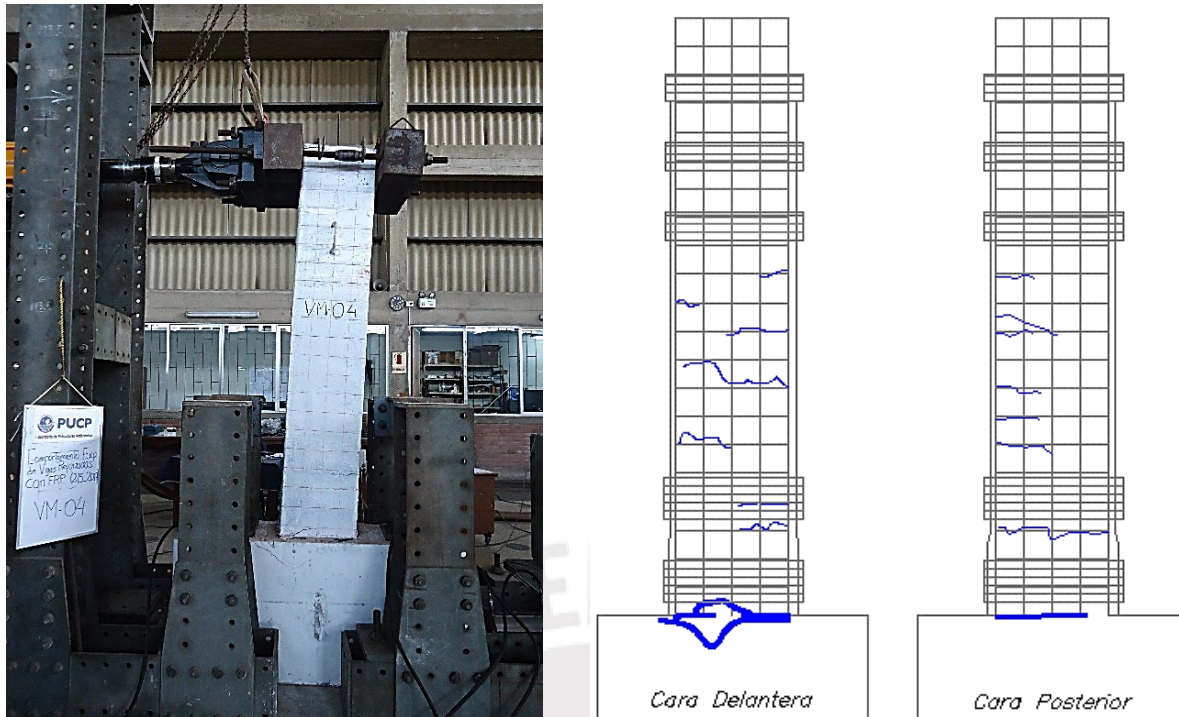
Mapeo de fisuras de la viga VM-04
